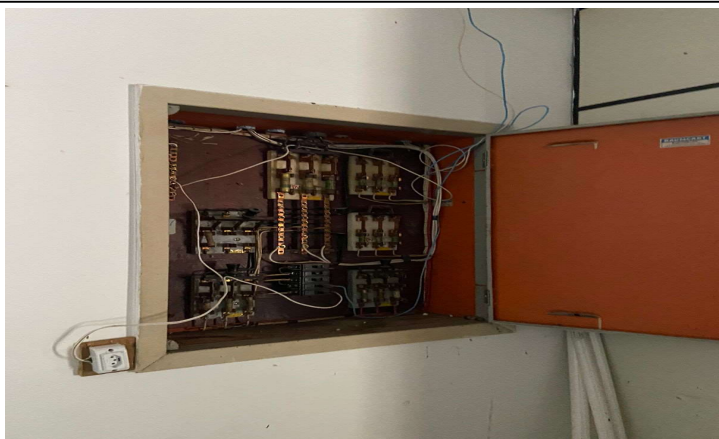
INSTALAÇÕES ELÉTRICAS COM ADAPTAÇÕES DE RISCO
